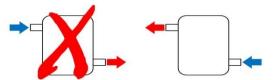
Collegamento scorretto (sin.) e collegamento corretto (dest.)
